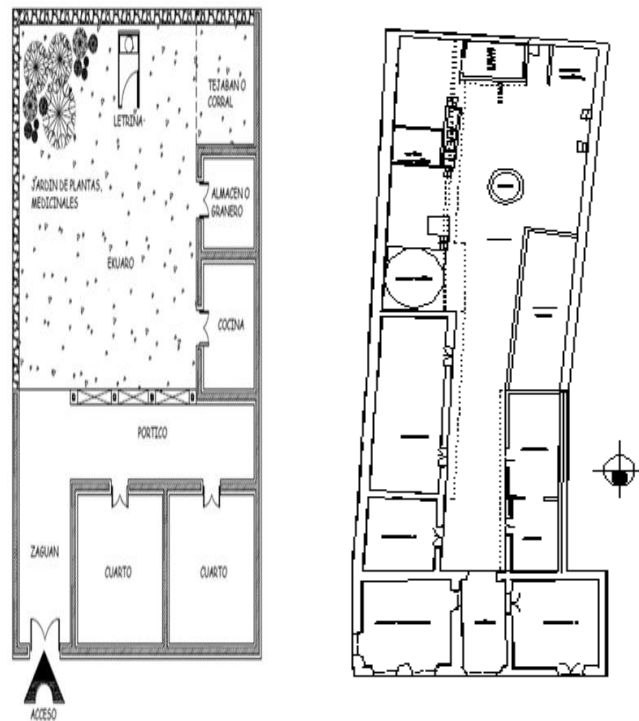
Comparativo de Planta Tipo de Vivienda Tradicional (izq.) y Planta de la Vivienda Tradicional de Estudio (der.)
